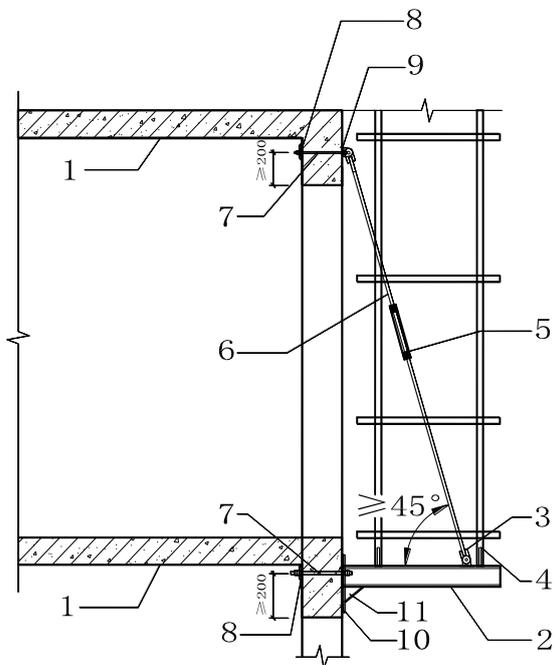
上拉式悬挑支撑结构的构造示意图
